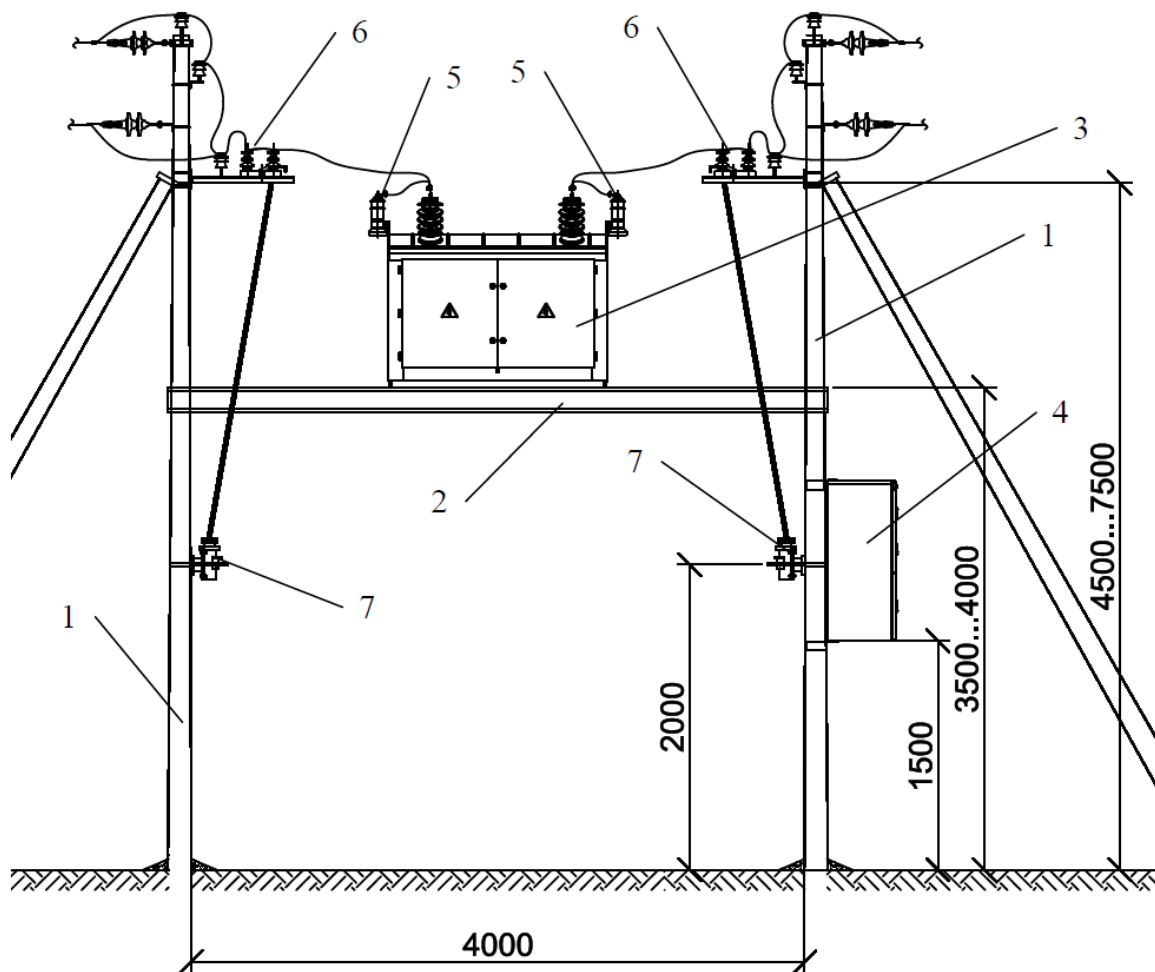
Установка ПСС. 1 – опора ЛЭП; 2 – рама; 3 – высоковольтный блок ПСС; 4 – шкаф управления; 5 – разрядники; 6 – разъединители; 7 – приводы разъединителей.
